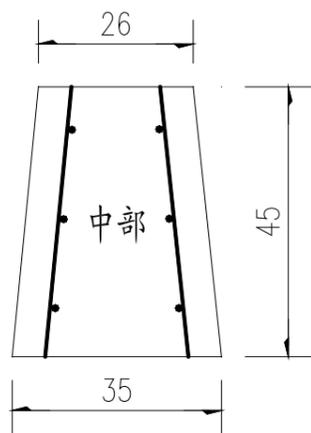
护栏中部 M_{w2} 计算简图 (尺寸单位: cm)
